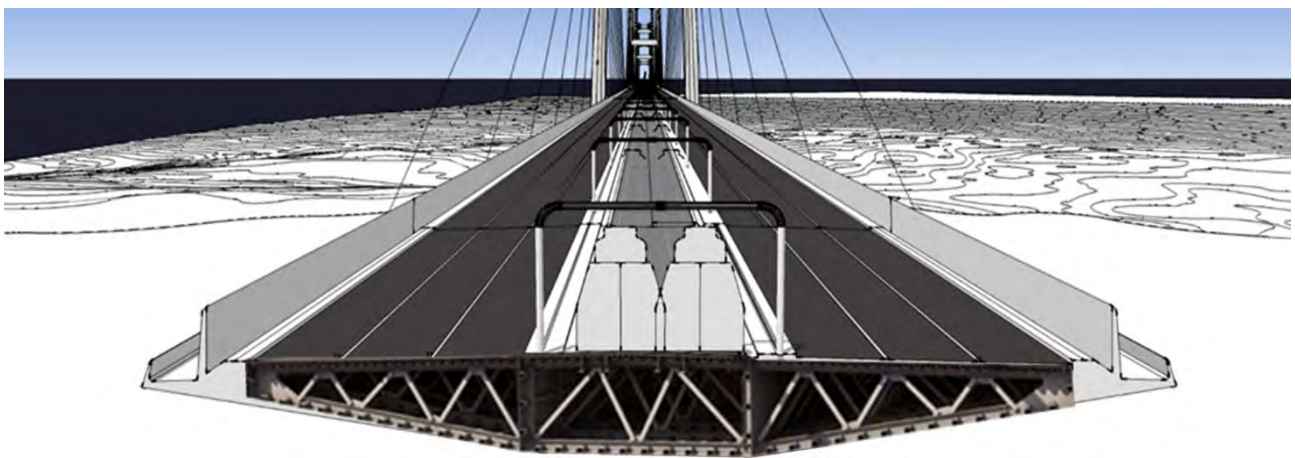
Sezione dell'impalcato del ponte ibrido multicampata ad unico piano
